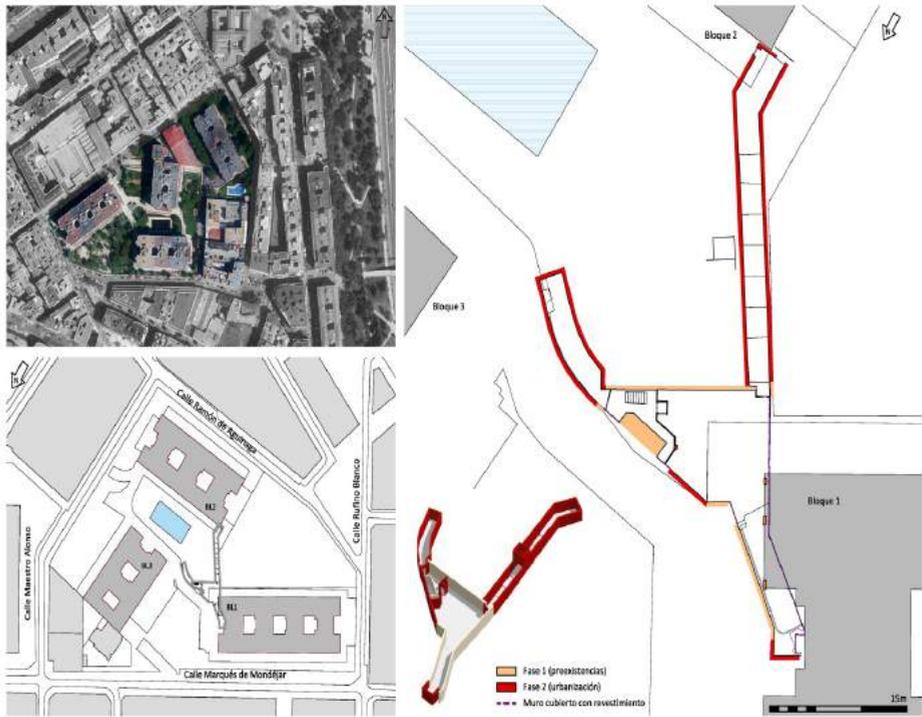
Planta de las galerías subterráneas superpuesta sobre la planta de la urbanización. (Imagen de los autores).
